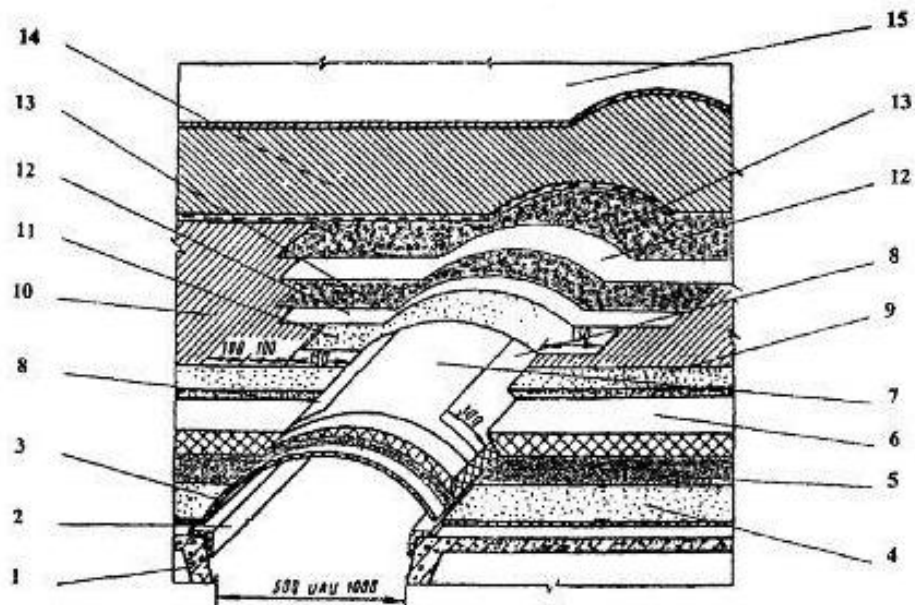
Усиление кровли в месте установки воронки внутреннего водостока
